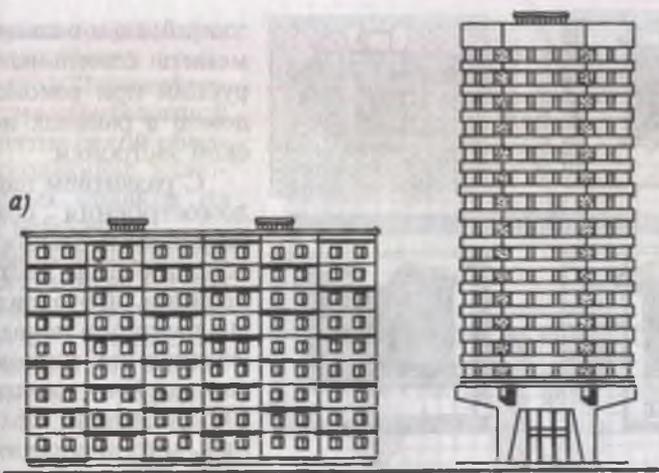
Примеры пластического или цветового выявления конструктивной разрезки наружных стен на панели:
